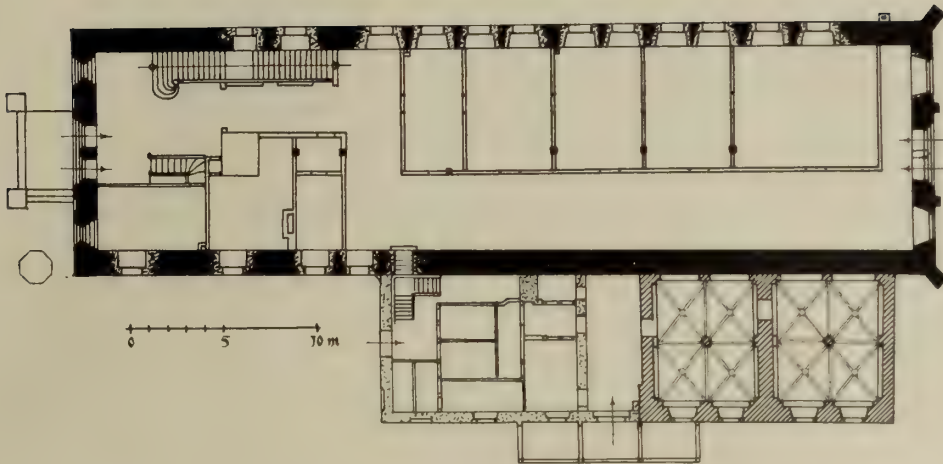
Erdgeschoßgrundriß des Neustädter Rathauses (vor dem Umbau).
